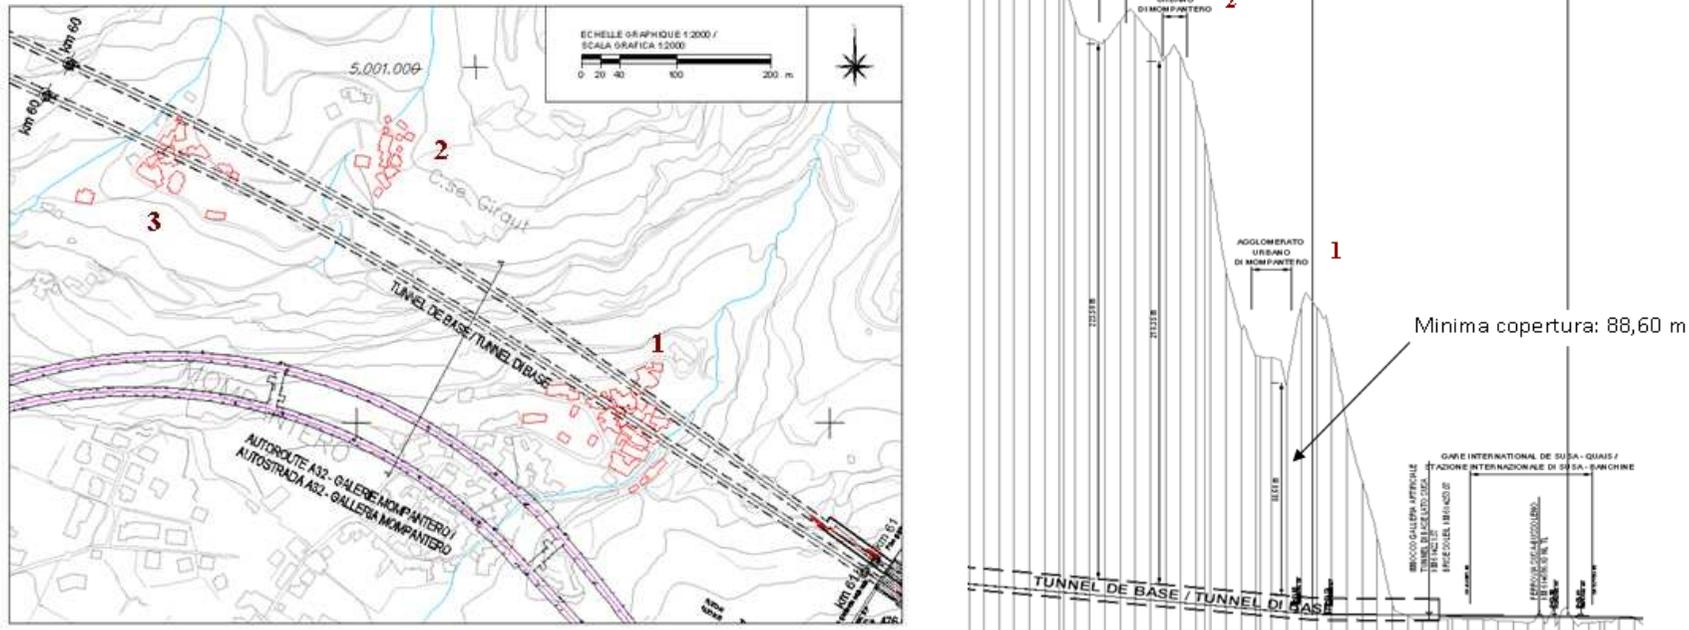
Stralcio Sottoattraversamento Mompantero - Planimetria + Profilo
